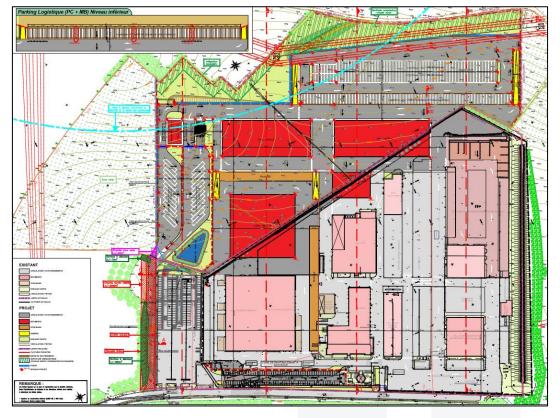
Extrait du plan « extension du site Lamesch à Bettembourg - Avant-projet » (Luxplan S.A. - 2021)
